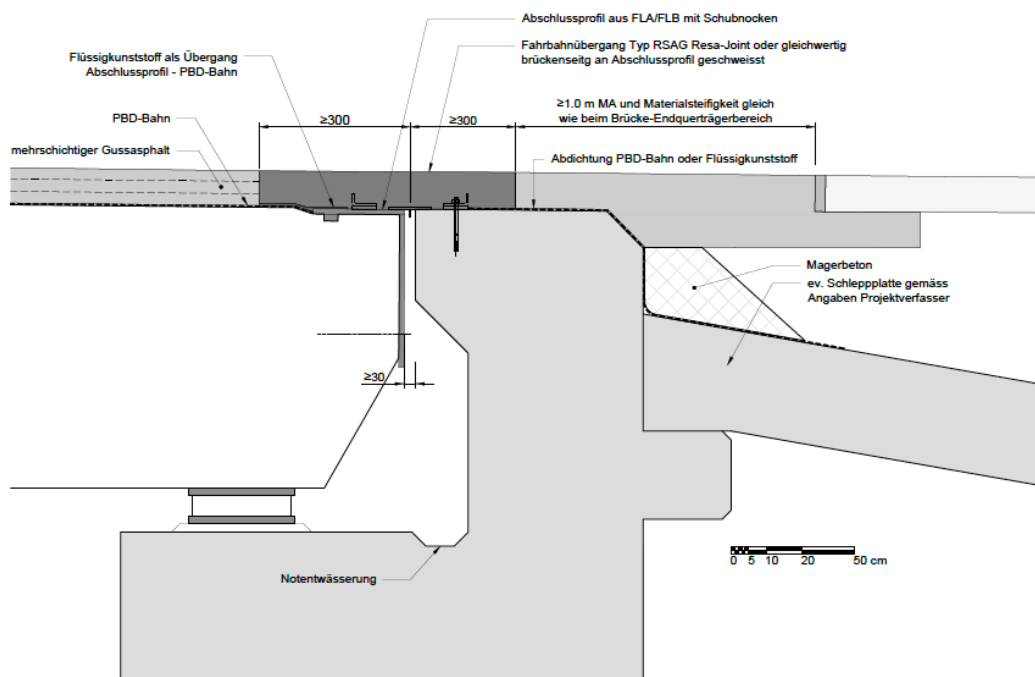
Detaillösung, Geschlossener Fahrbahnübergang mit Jointfuge.
